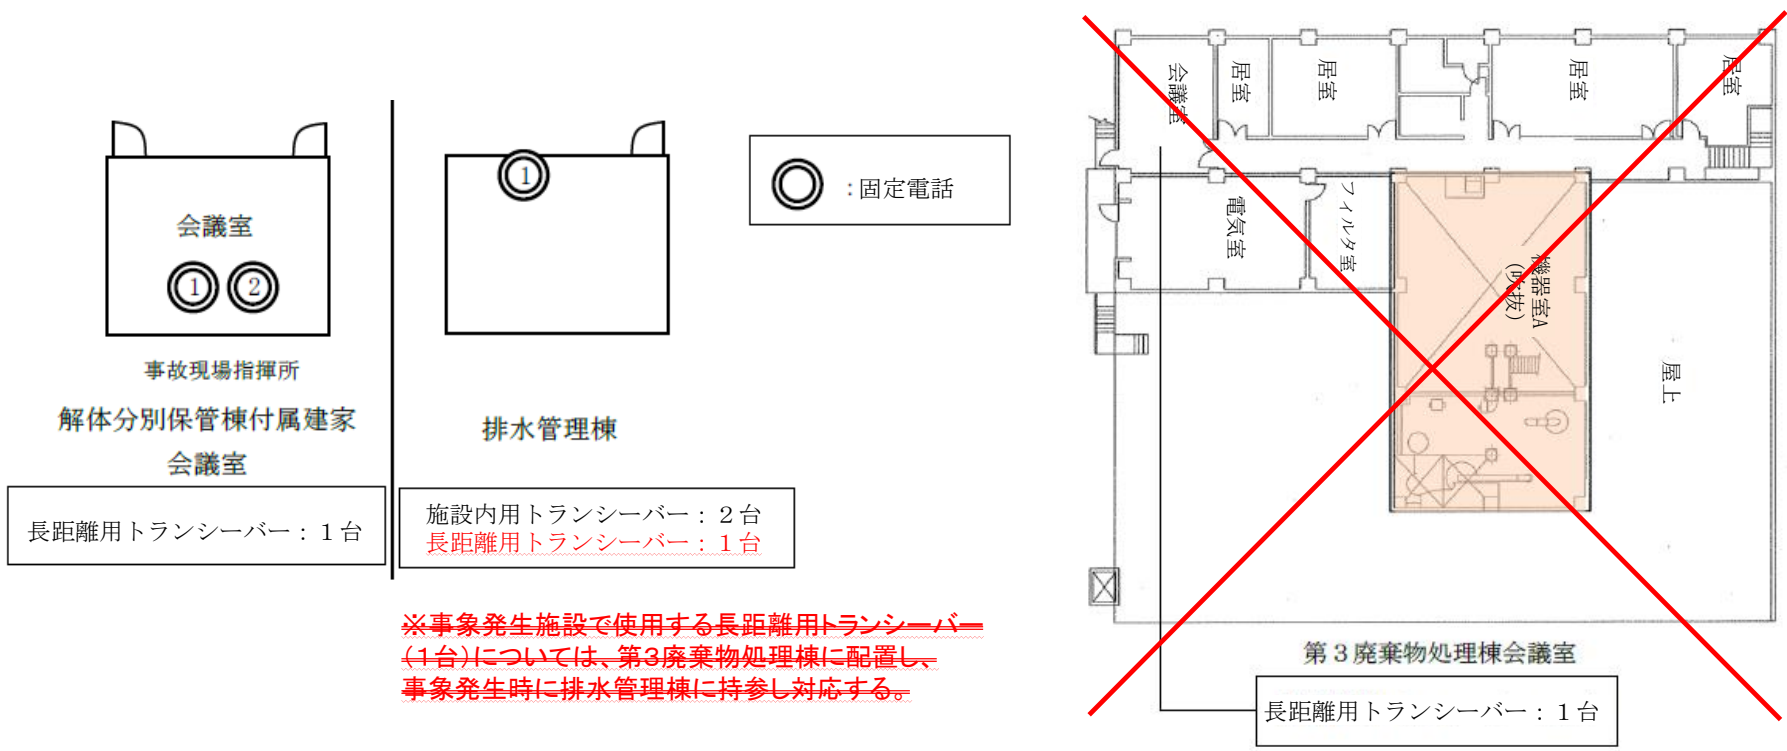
保管廃棄施設・L及び排水貯留ポンドの通信連絡設備の配置図
